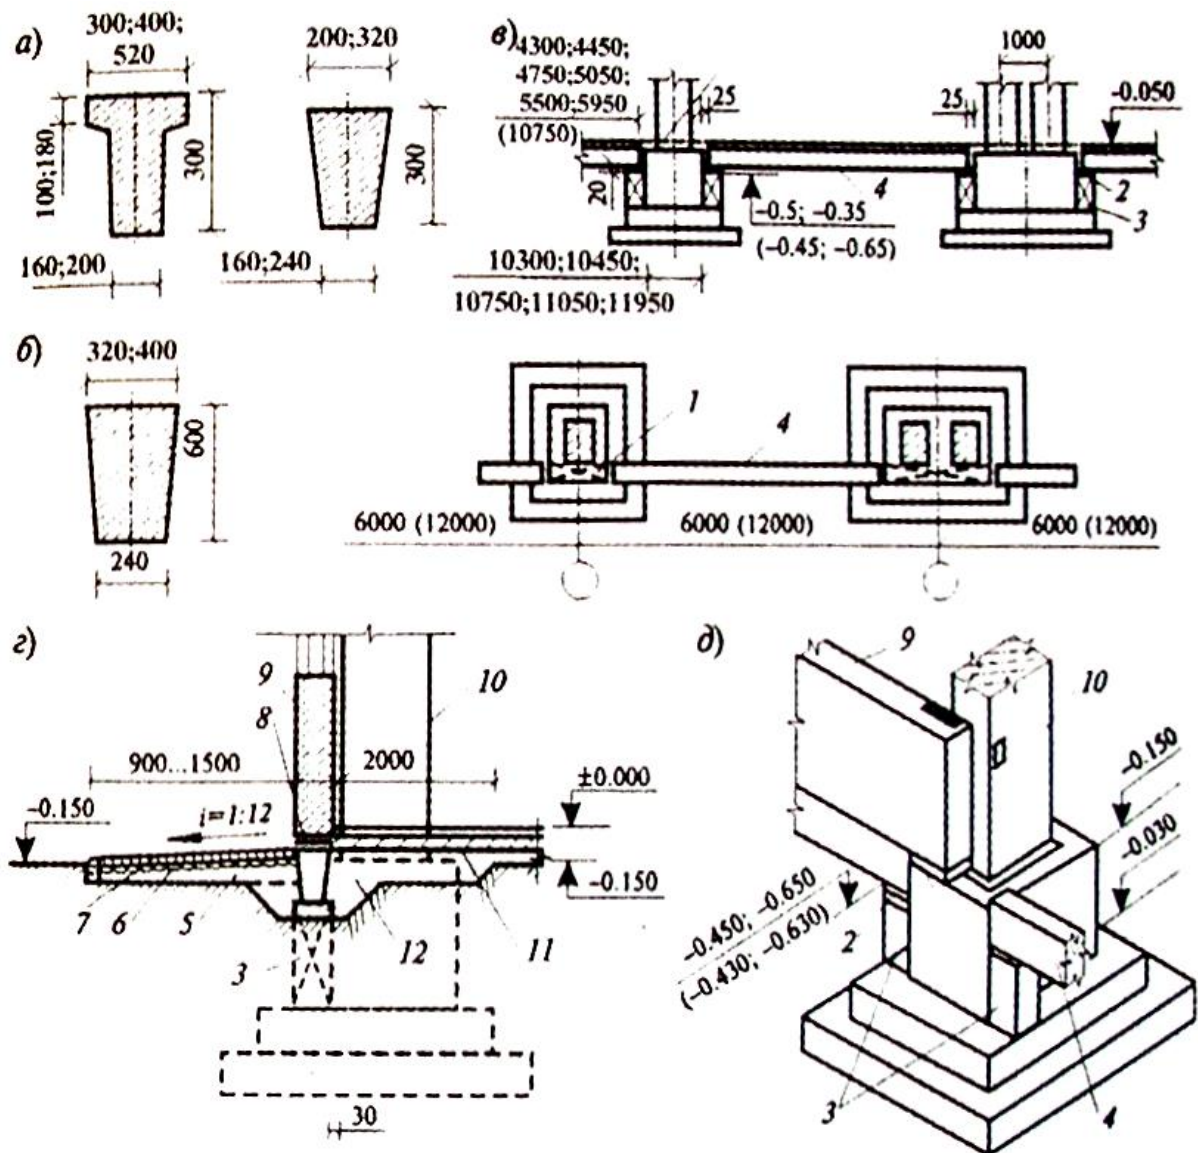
Фундаменты одноэтажного промышленного здания:
